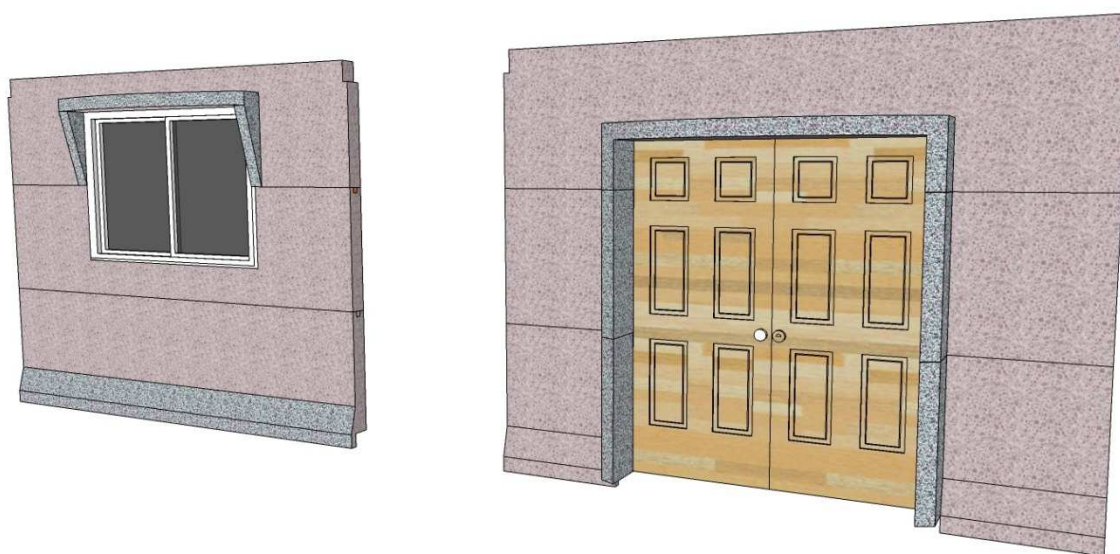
Panneau de façade (type 2) l'un avec porte et l'autre avec fenêtre
